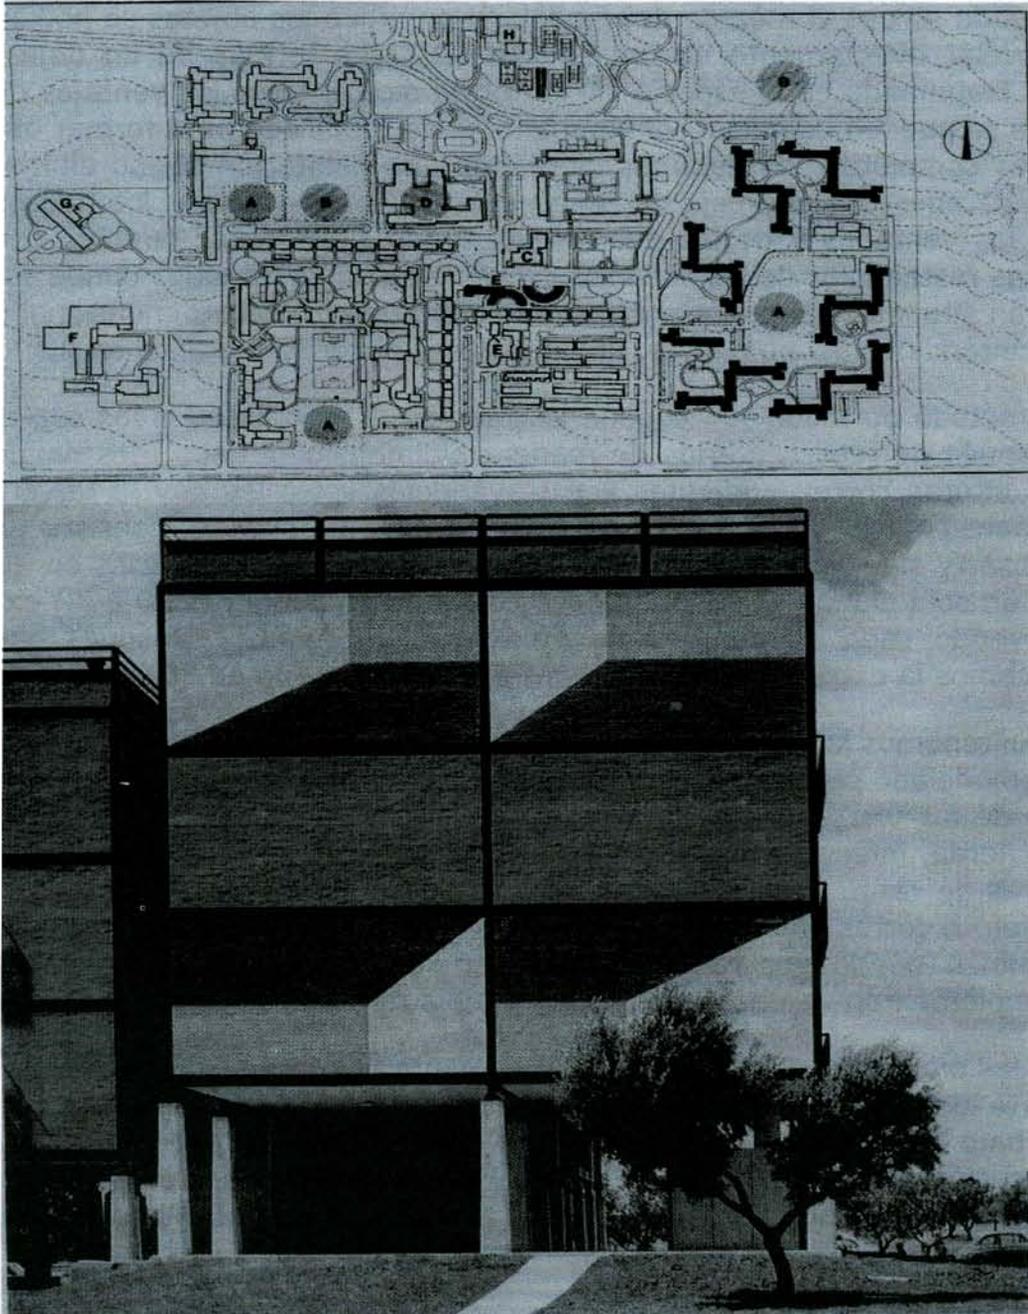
MODELADO TRIDIMENSIONAL DE UNA EDIFICACIÓN DE UN COMPLEJO DE CONSTRUCCIONES SIMILARES VISTAS EN PLANTA Y ELEVACIÓN
